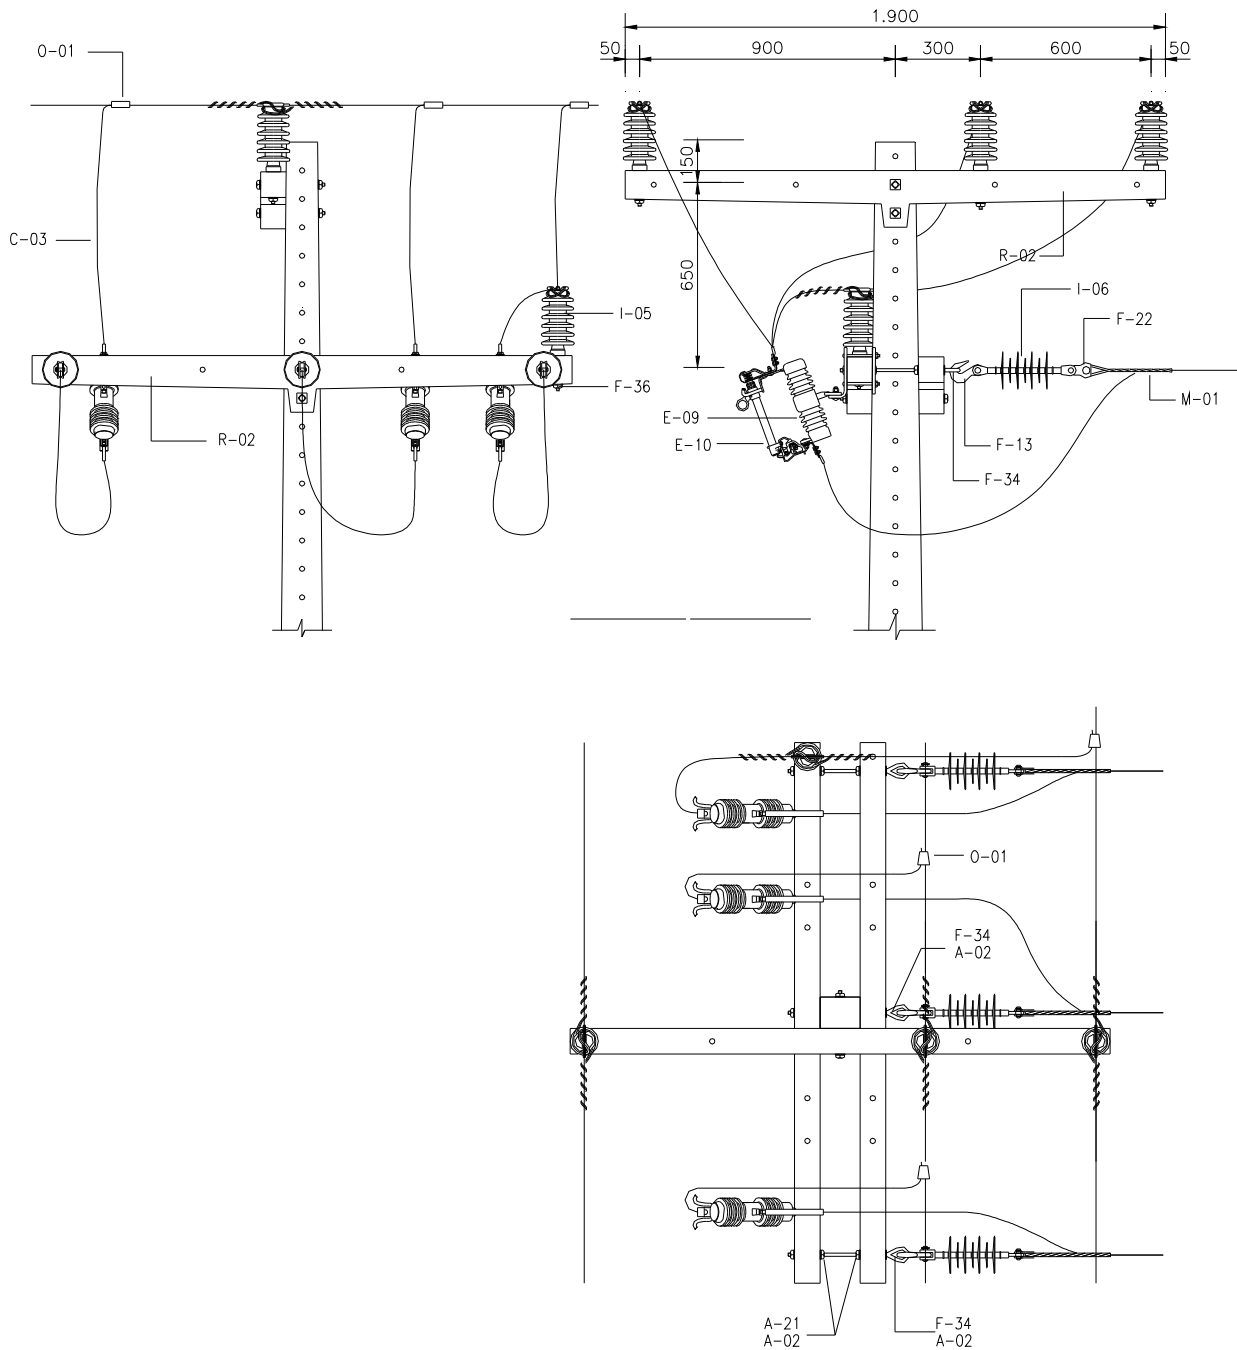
Instalação de equipamentos – Chave fusível em ramal
